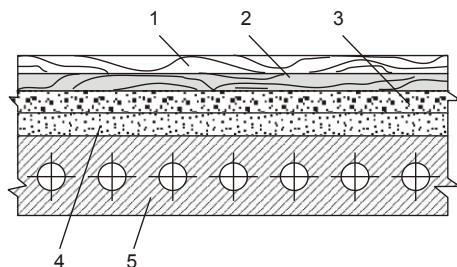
Конструкция пола из сверхтвердых древесно-волокнистых плит по перекрытию из многопустотных панелей:
